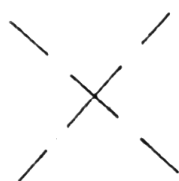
Позначення ліній на будівельному кресленні
